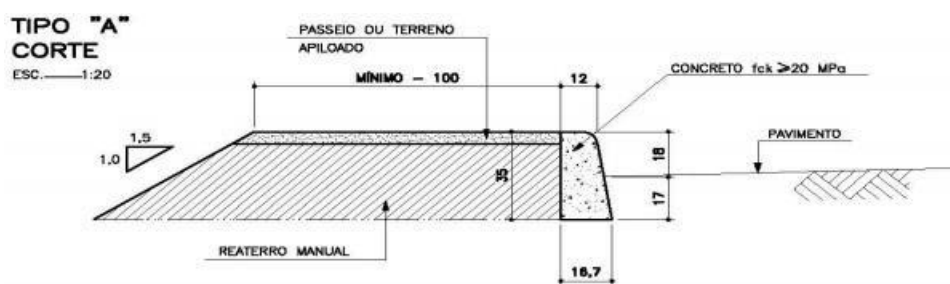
Meio Fio de Concreto Tipo A – padrão Sudecap
